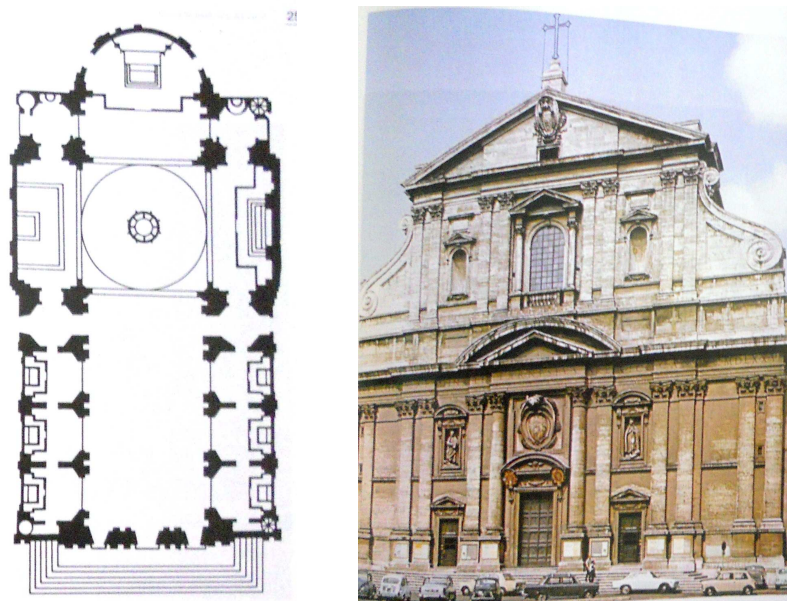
Vignola, Igreja de Gesù, em Roma, 1568. Planta e Alçado. Fonte - Pinto et al. N.º6, p.19.
